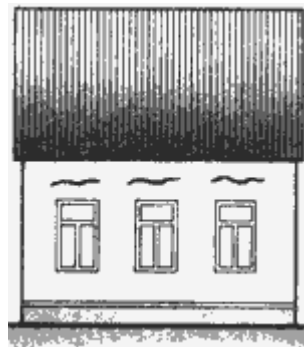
Образование трещин в стенах из-за прогиба балочного перекрытия.
